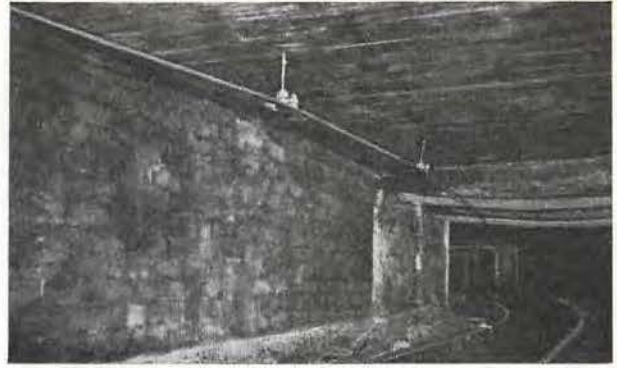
Parois latérales et plafond d'un crossing rendu étanche par ce procédé.
